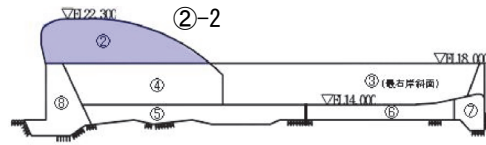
右岸みお筋部の撤去状況 (②堤体上部-1)
